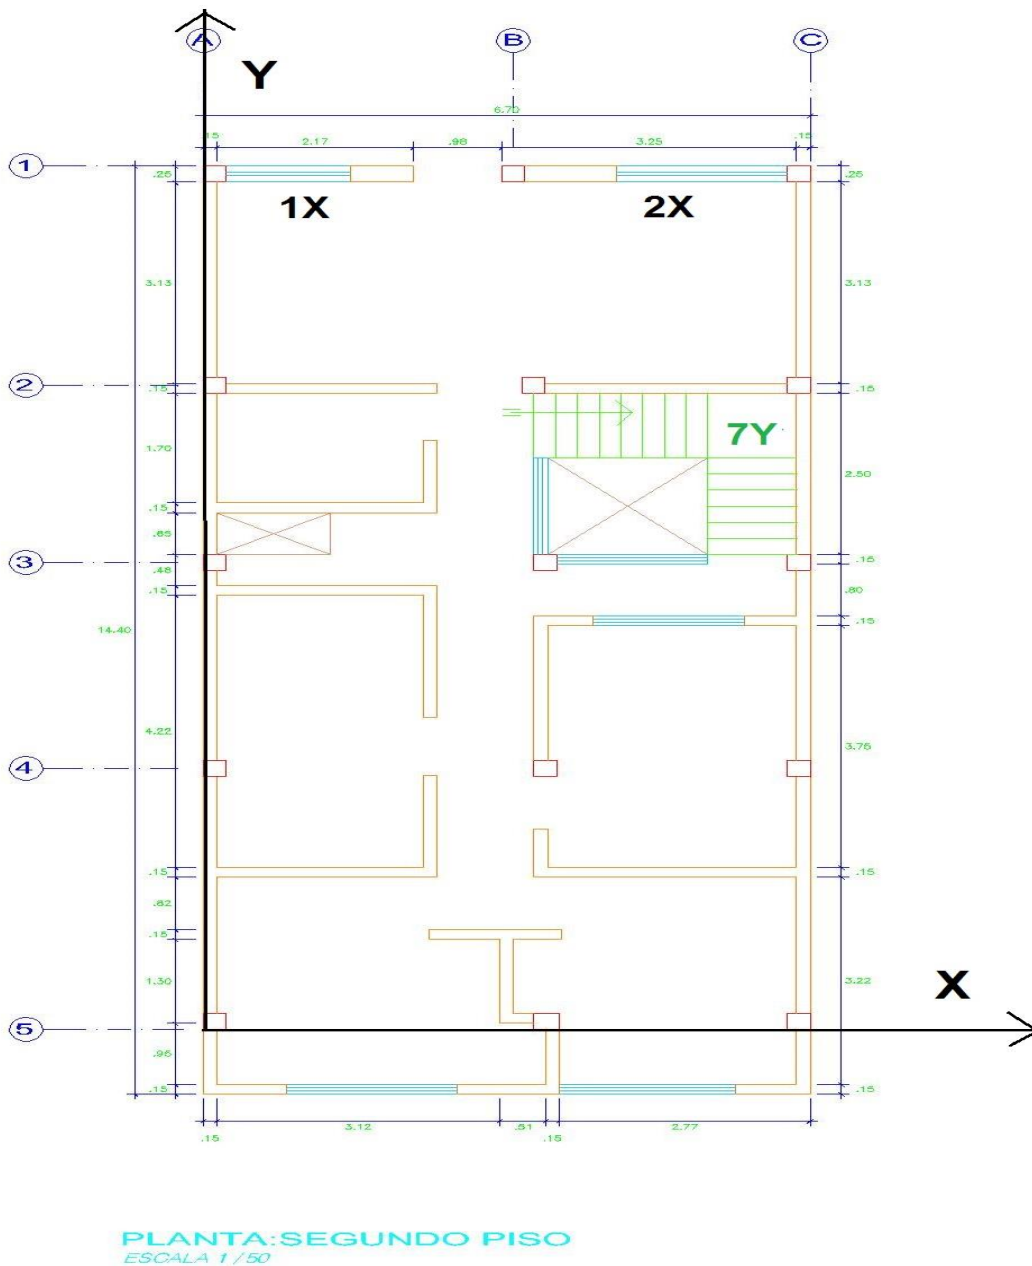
Enumeración de muros en vista en planta del segundo piso - Lote 39 (Fuente: Elaboración propia)
